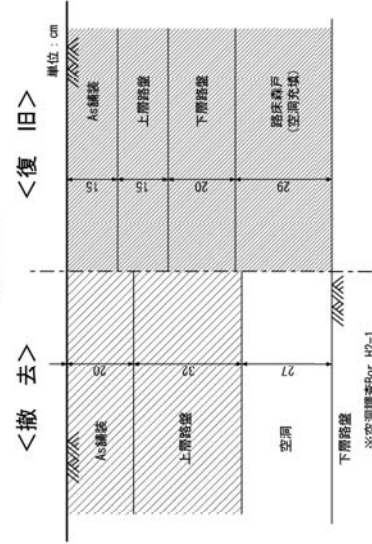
(a) 箱崎埠頭-12m岸壁の被災・復旧標準断面図
